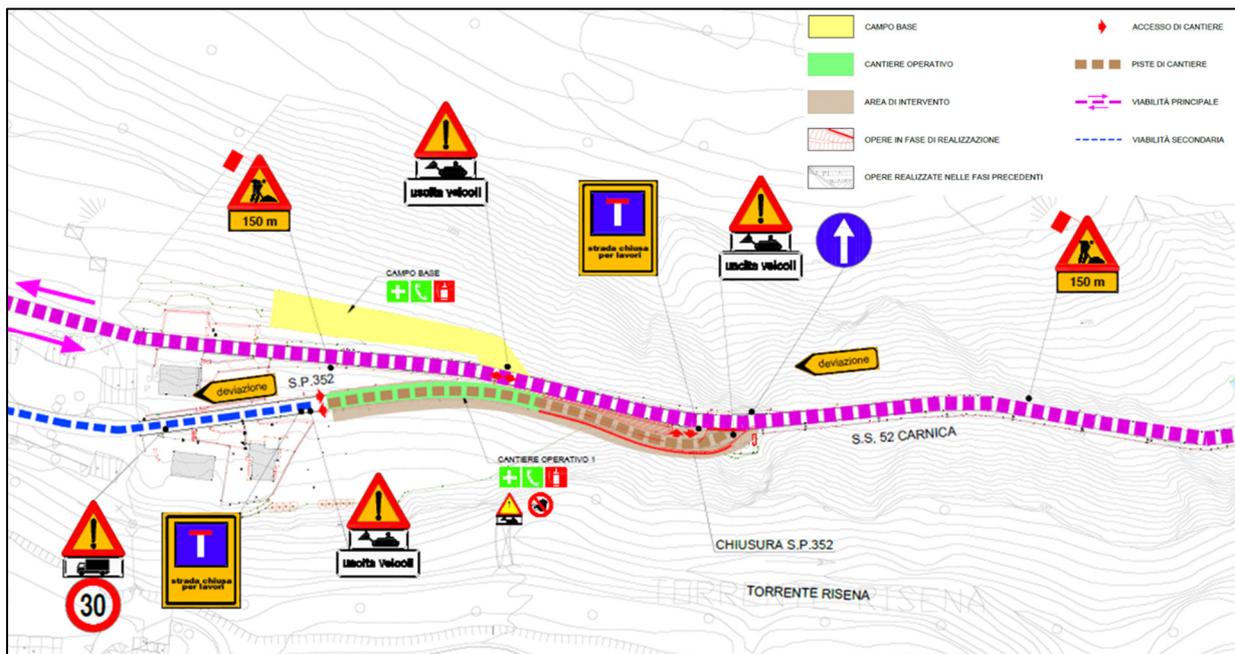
Cantierizzazione Fase 1 – Estratto elab. T00CA00CANPL01A
